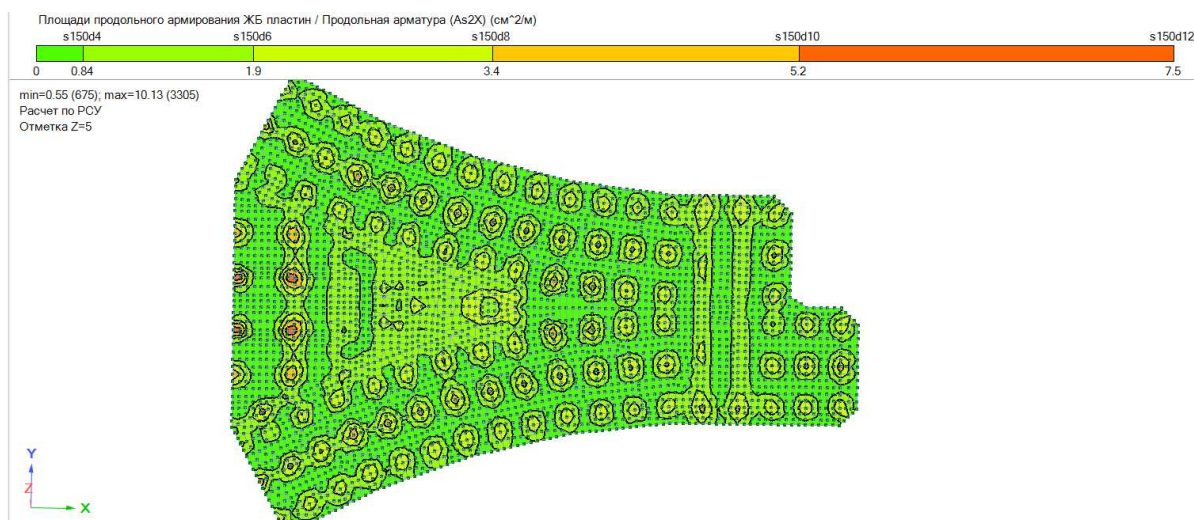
Зоны верхнего дополнительного армирования по оси X
